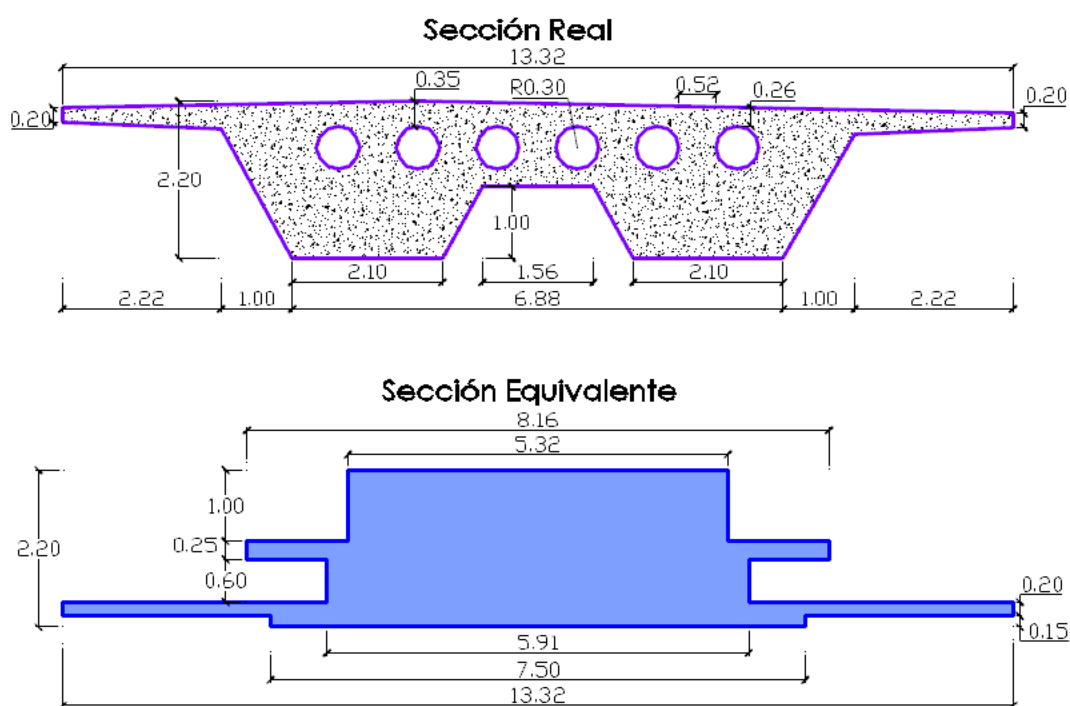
Sección sobre apoyo Pila 3, H=2.20m.
